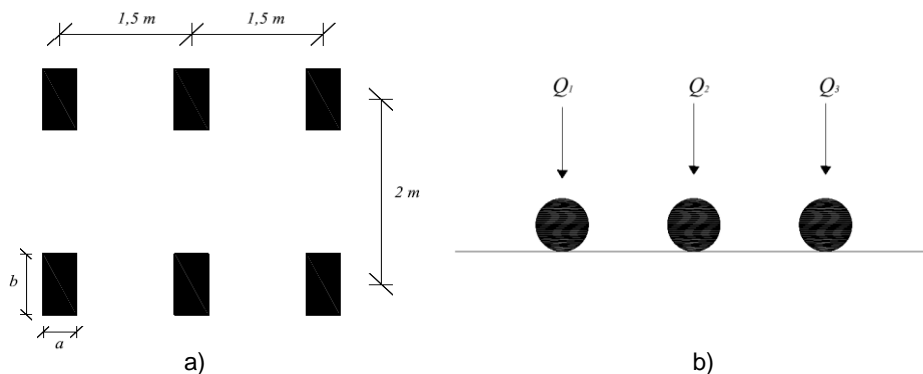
Veículo tipo RSA planta a) e alçado b) [30].
